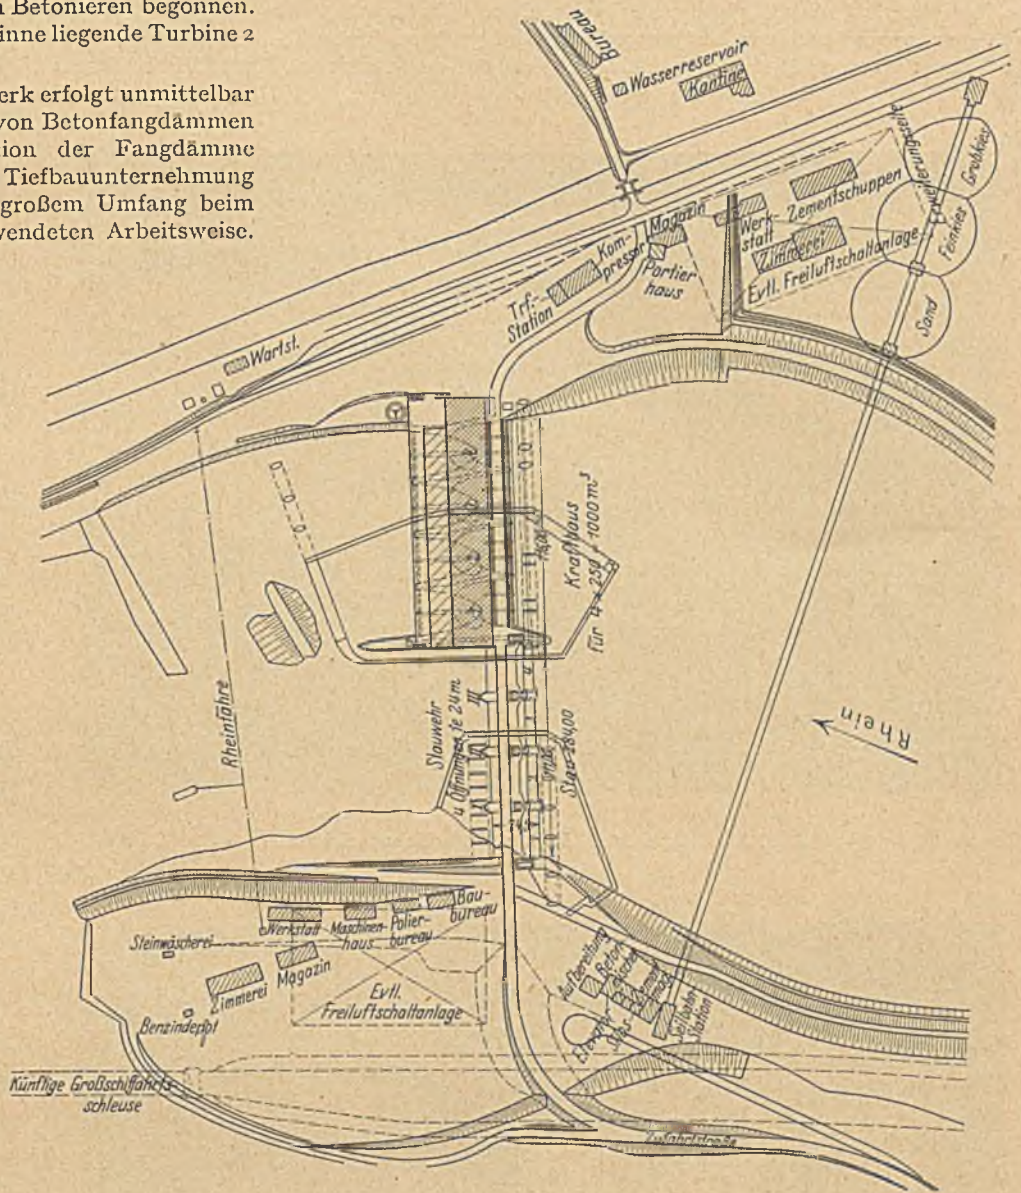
Kraftwerk Ryburg-Schwörstadt, Lageplan.
